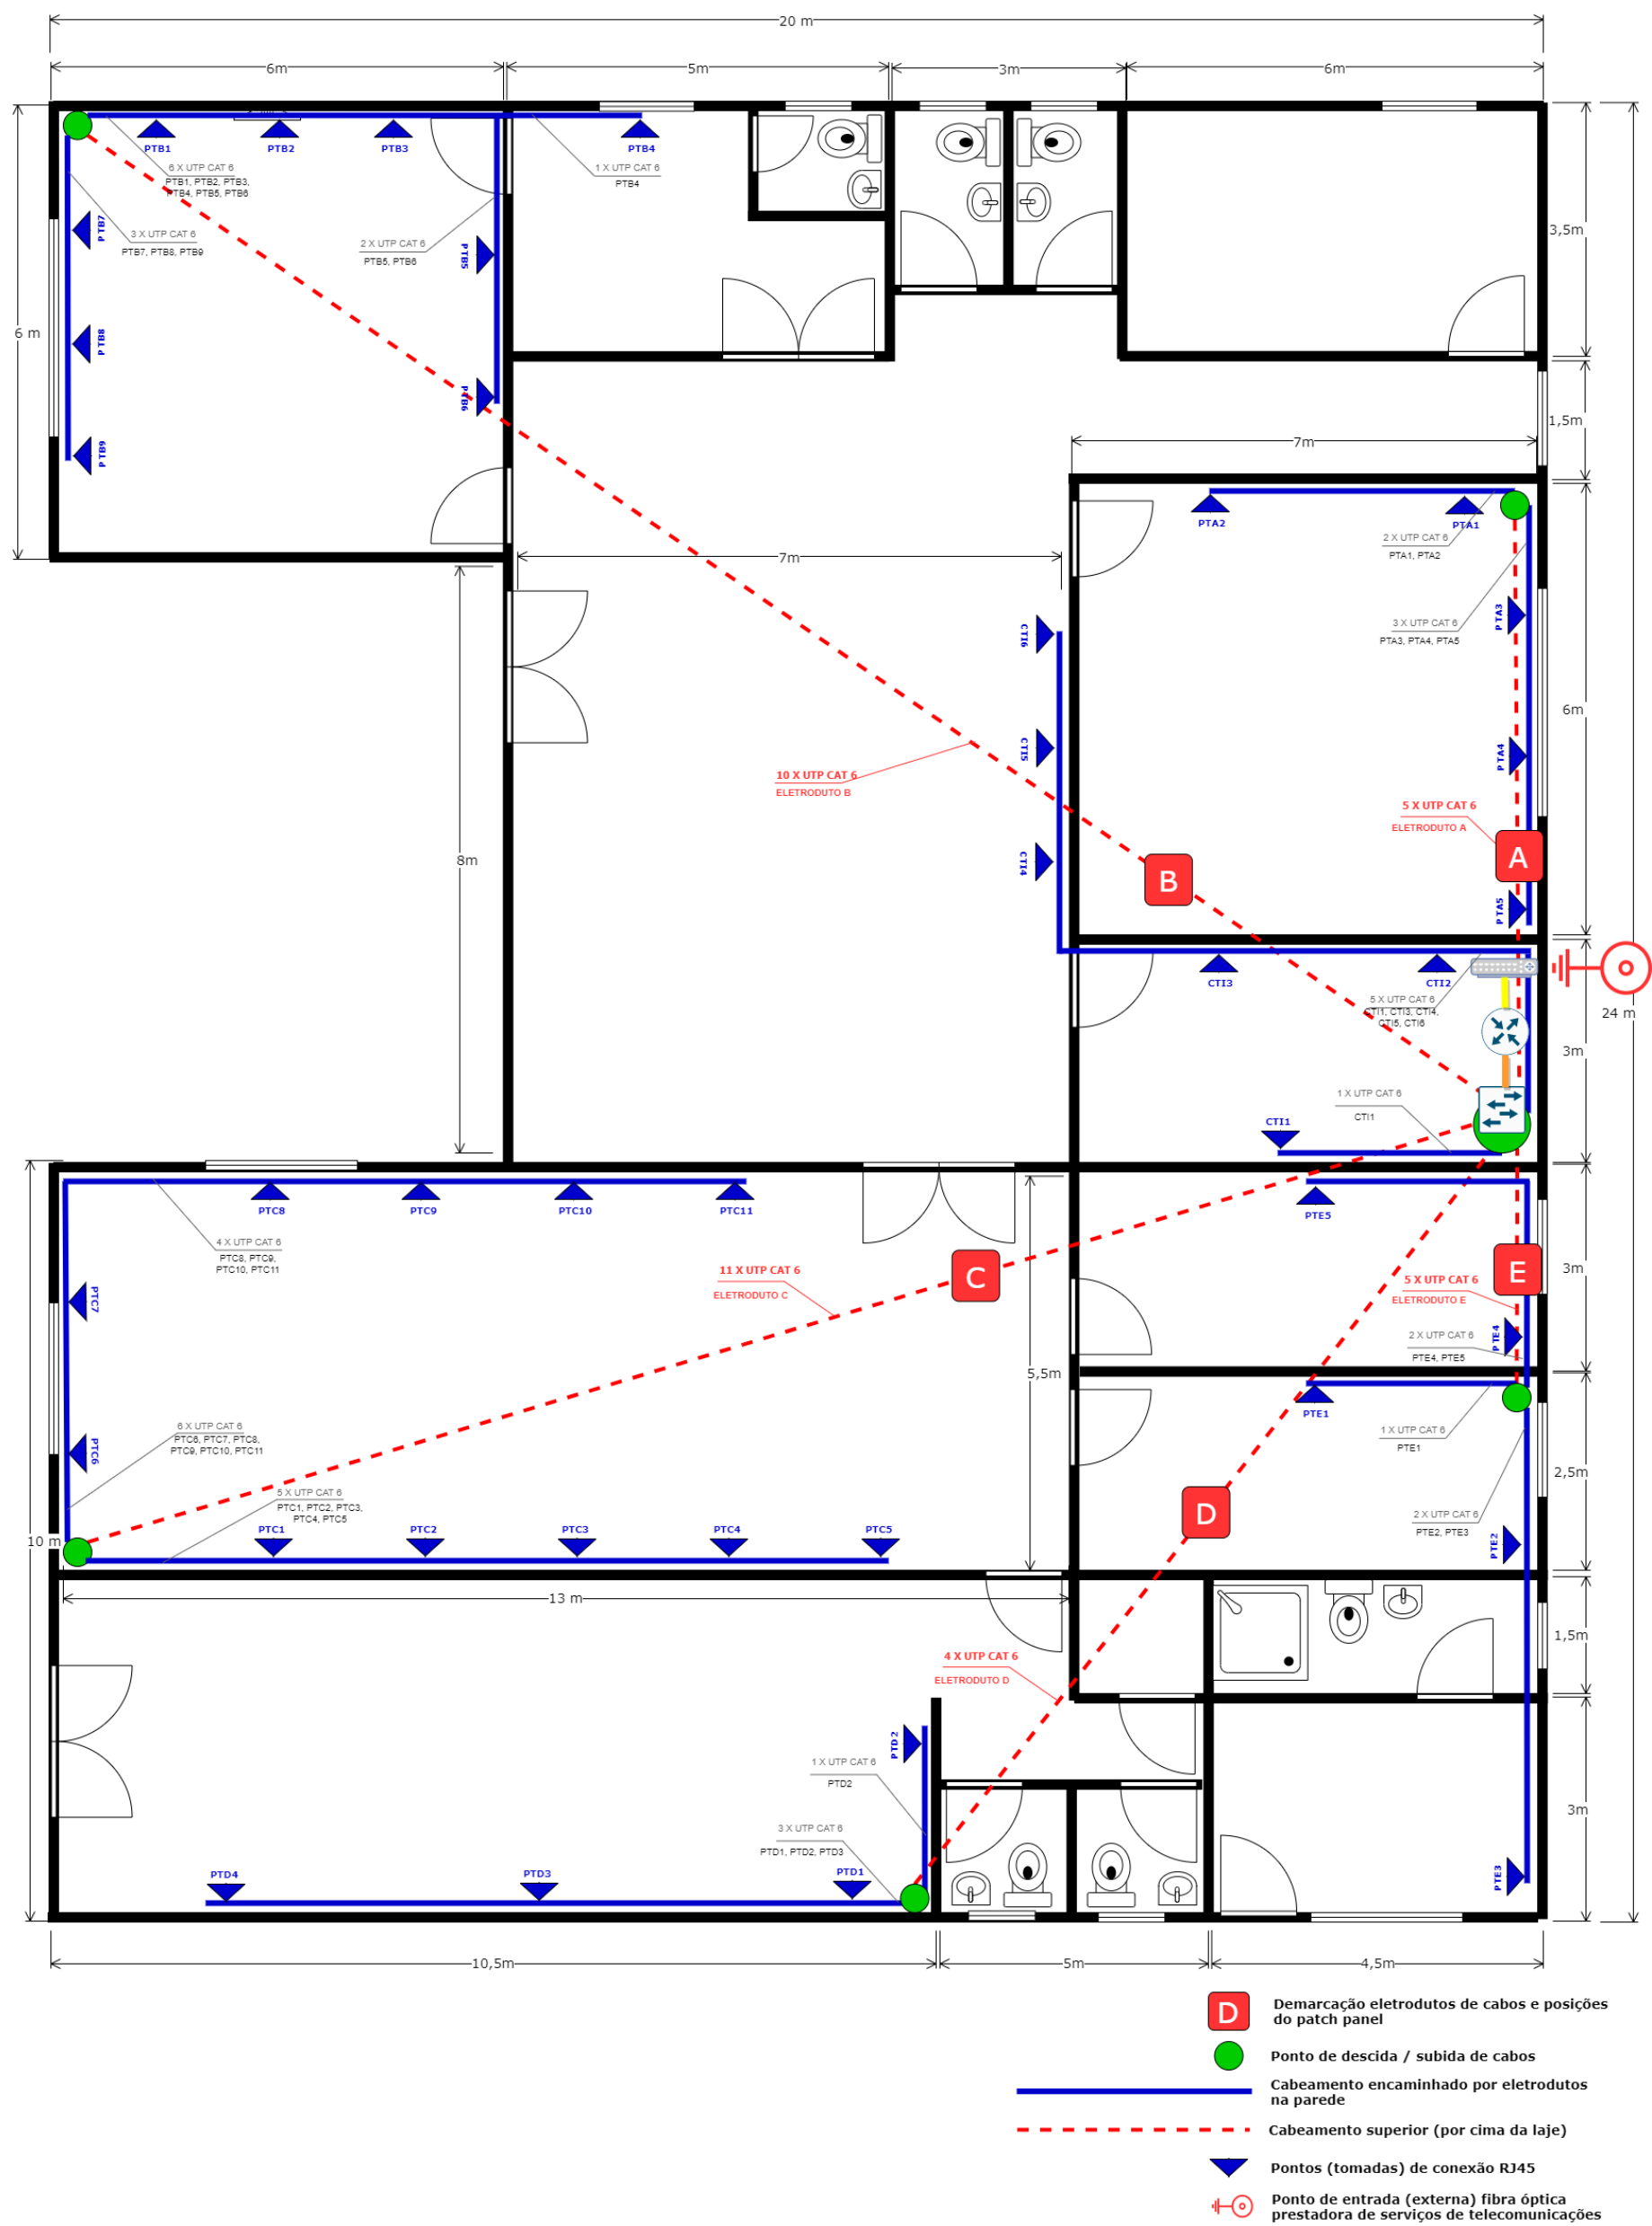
Planta Baixa do Edifício da Empresa APS Engenharia.
